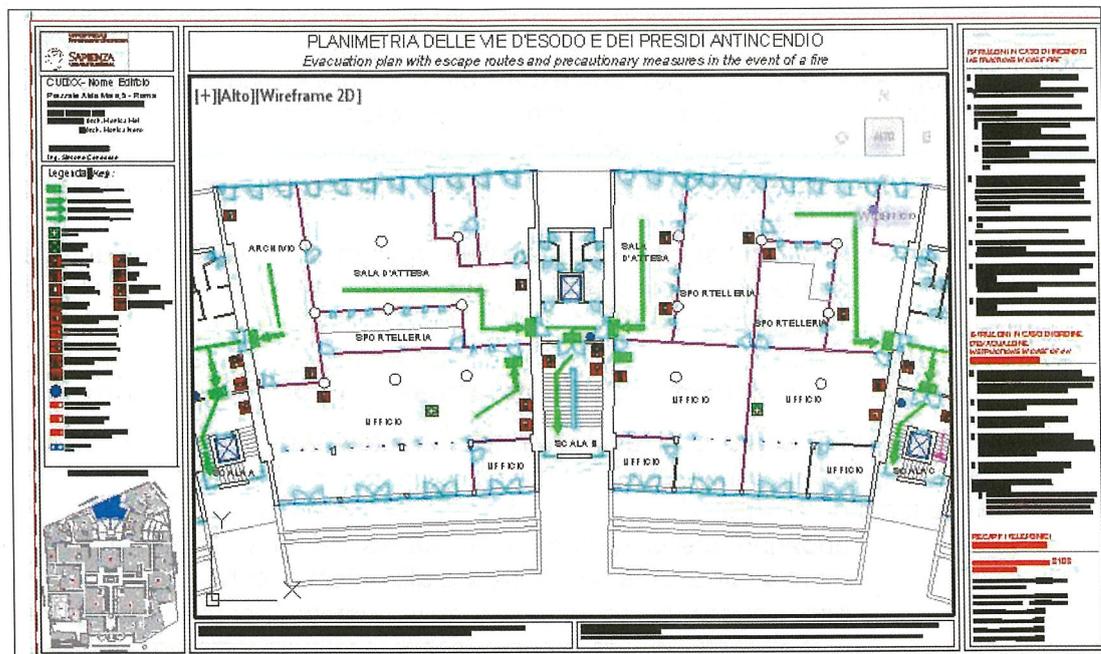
Esempio di Planimetria riportante le Vie di Fuga
